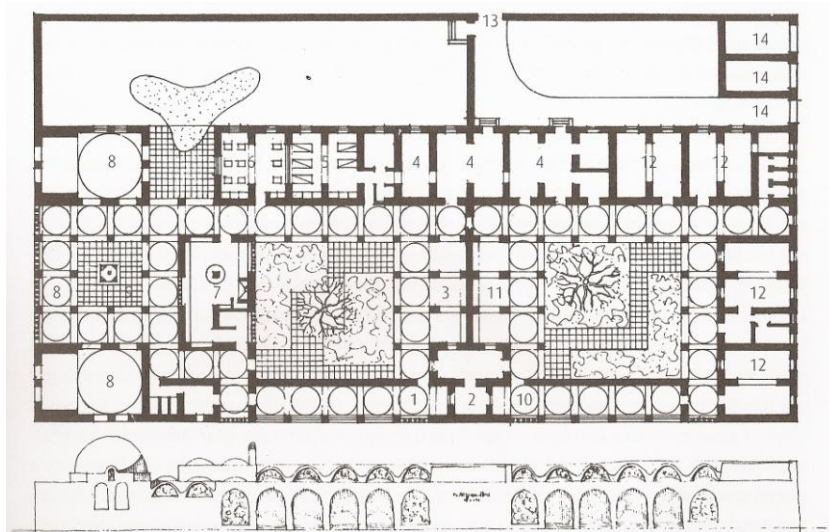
Planta e alçado do centro de higiene do projecto para New Gourná, p.151.
